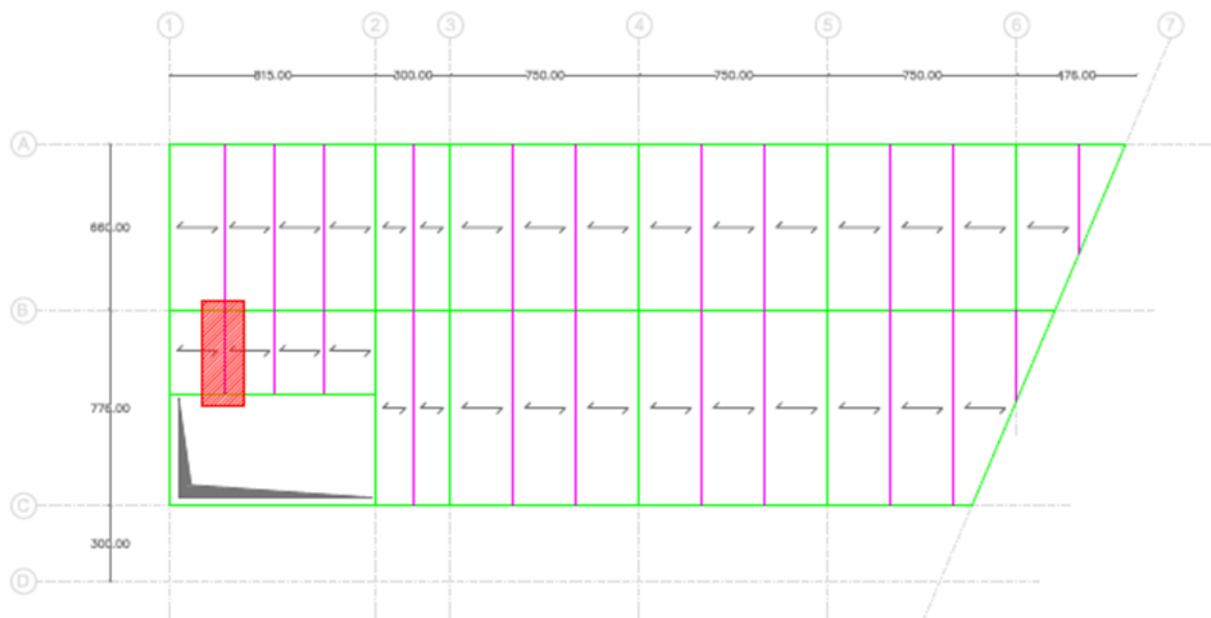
Individuazione della trave nello schema del solaio interpiano
